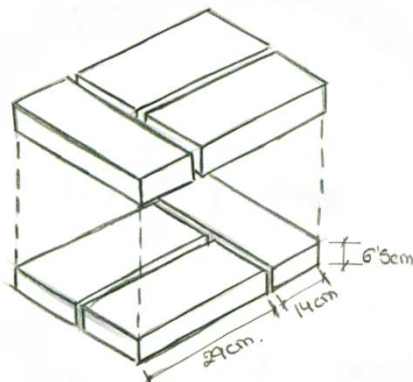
Pilar de ladrillo macizo. Elaboración propia
